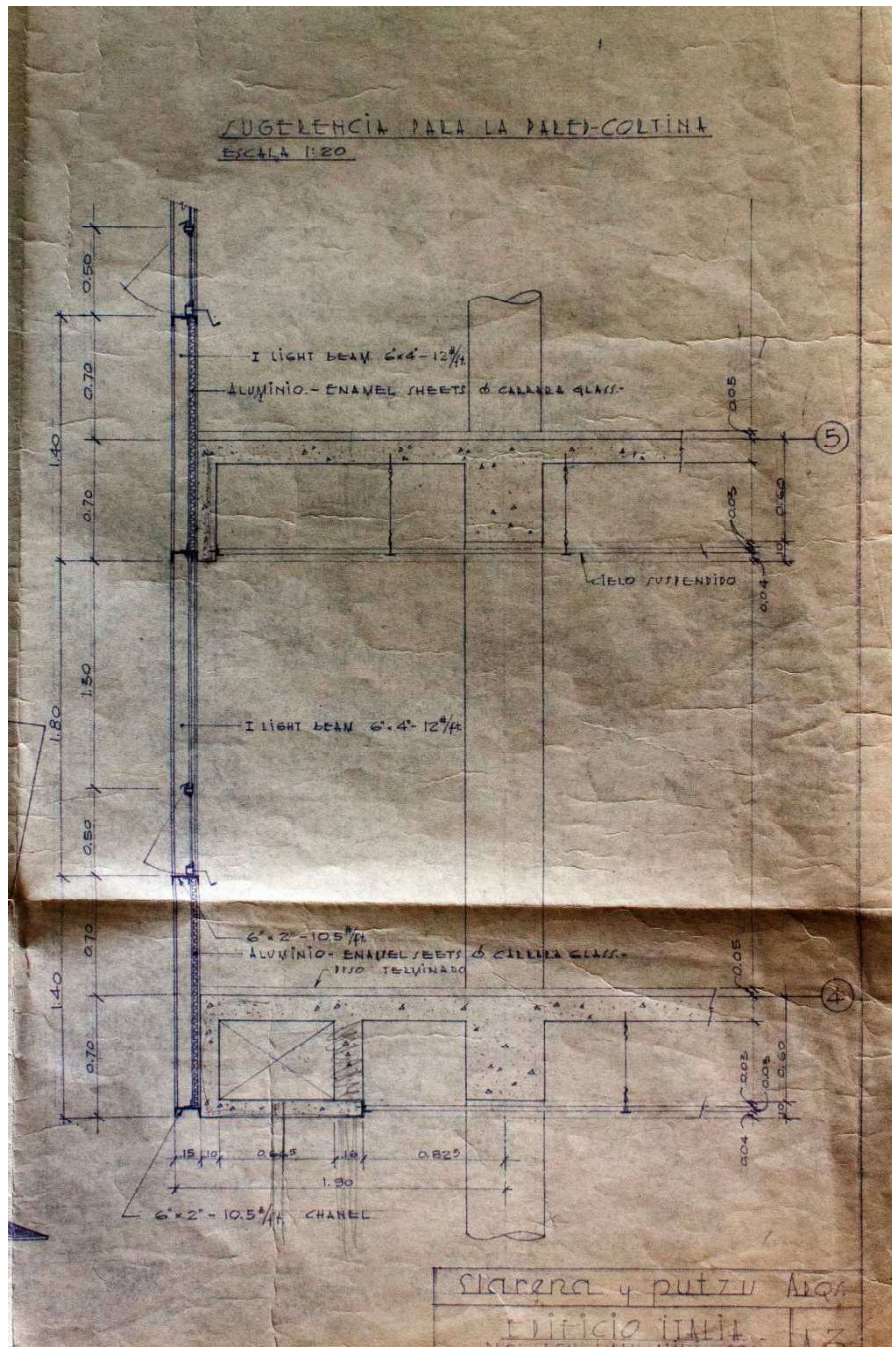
Detalle de copia de plano original de muro cortina 1957, edificio Italia.
